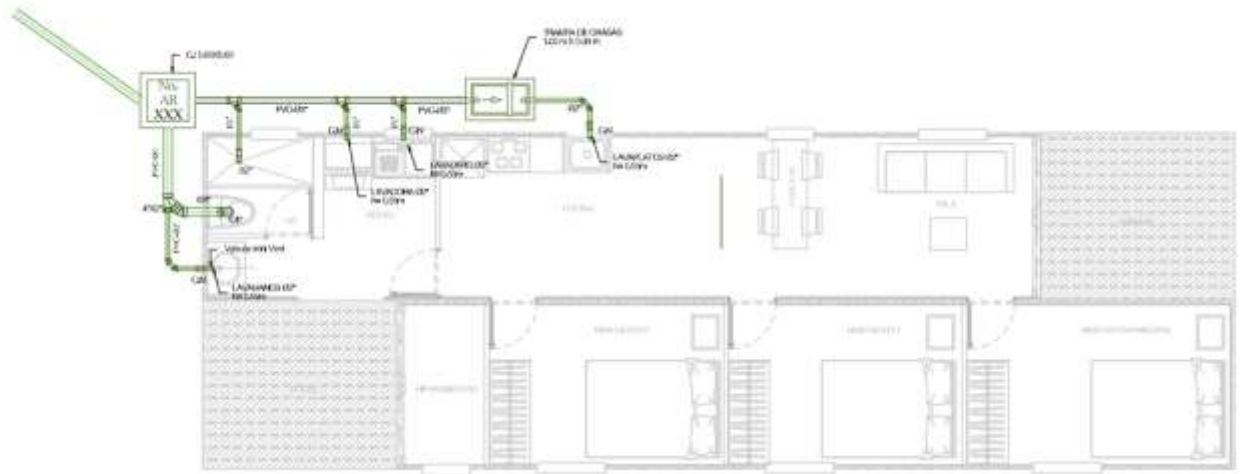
, Planta Diseño Residual #1, 2025-II, Wilson Lozano
